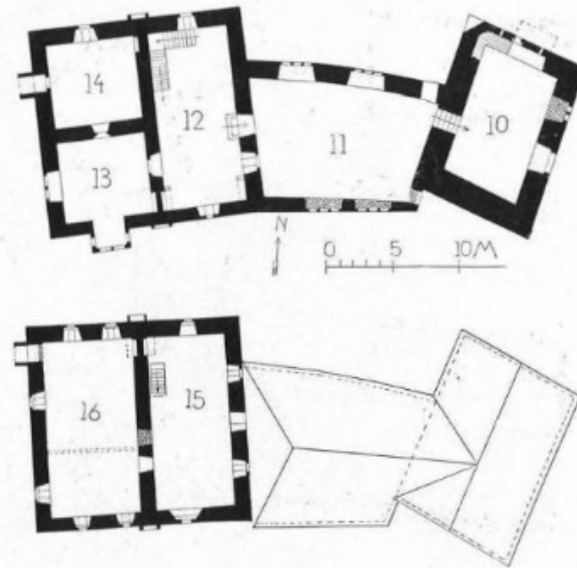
Grundrisse aus dem ältesten Teil der Oberburg. Erklärung: II. Stockwerk: 10 bewohnbarer Raum ober der Kapelle, 11 Saal, 12 Vorraum mit Stiegeeinbau, 13 und 14 Wohnräume mit reicher Bauausstattung und Erker. III. Stockwerk: 15 Vorraum, 16 großer, ehemals unterteilter Raum mit Sitznischen an den Lichtwegen.
